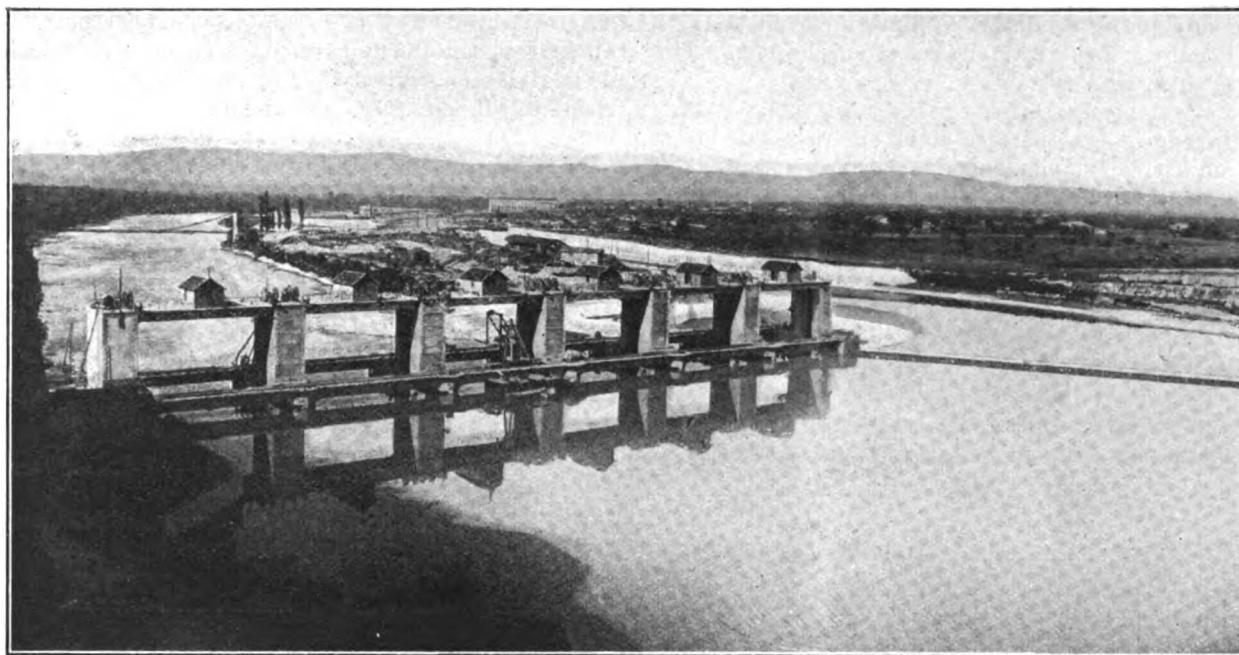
Vue d'ensemble, prise de l'amont, du barrage de l'usine de Beaumont-Monteux (au fond, vue de l'usine).
